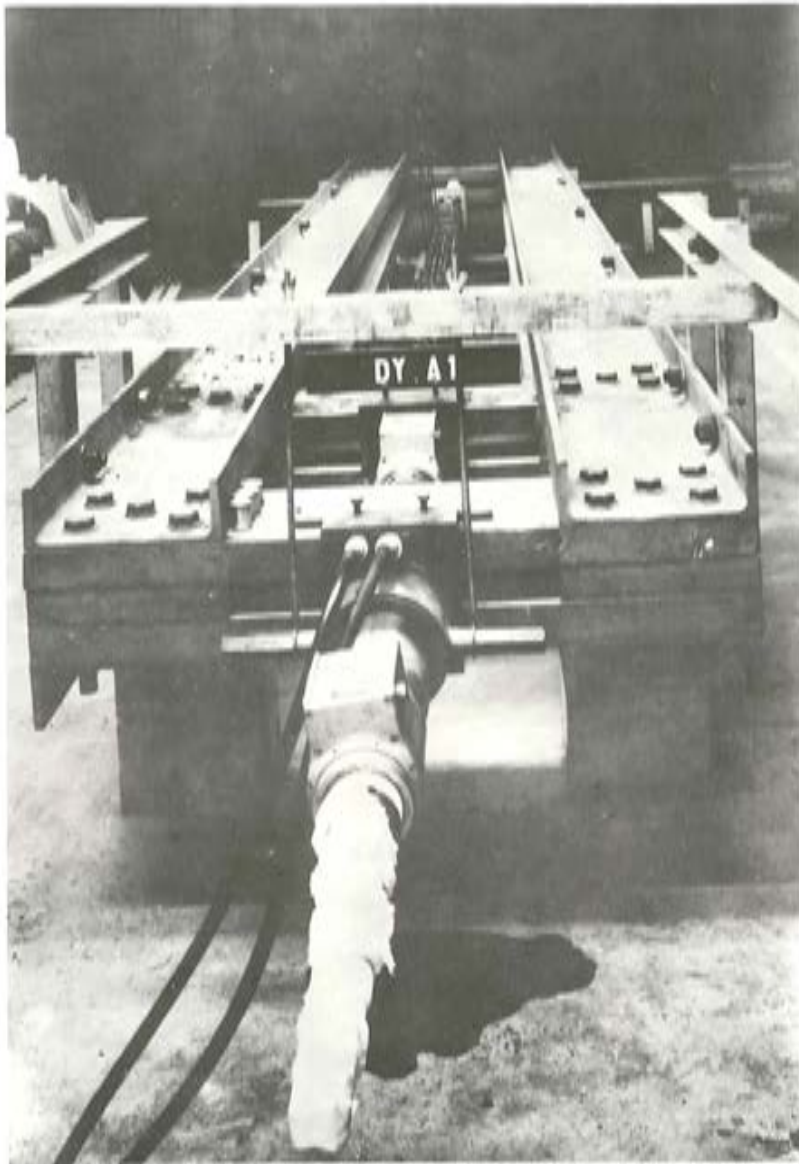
Banco para poner en tracción las armaduras de pretensado.
